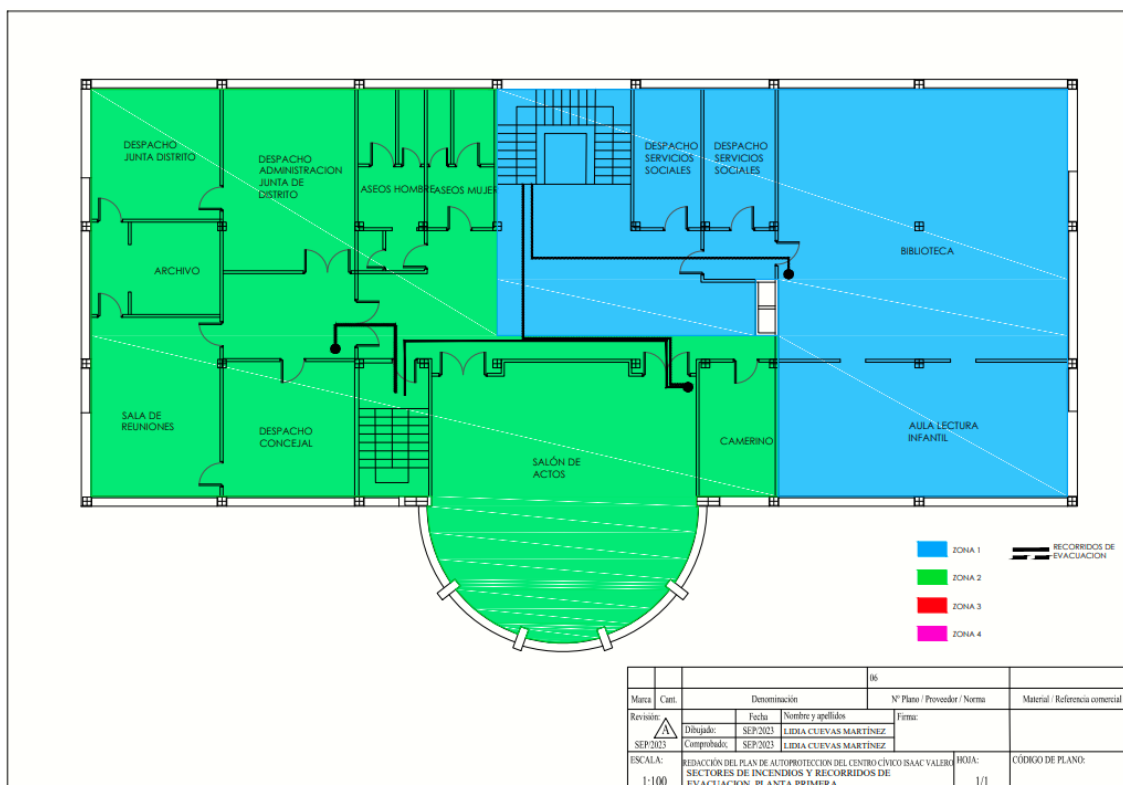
Plano dependencias y zonas planta primera. Fuente: Elaboración propia .
